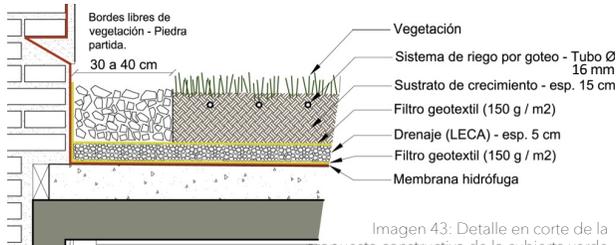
Detalle en corte de la propuesta constructiva de la cubierta verde
